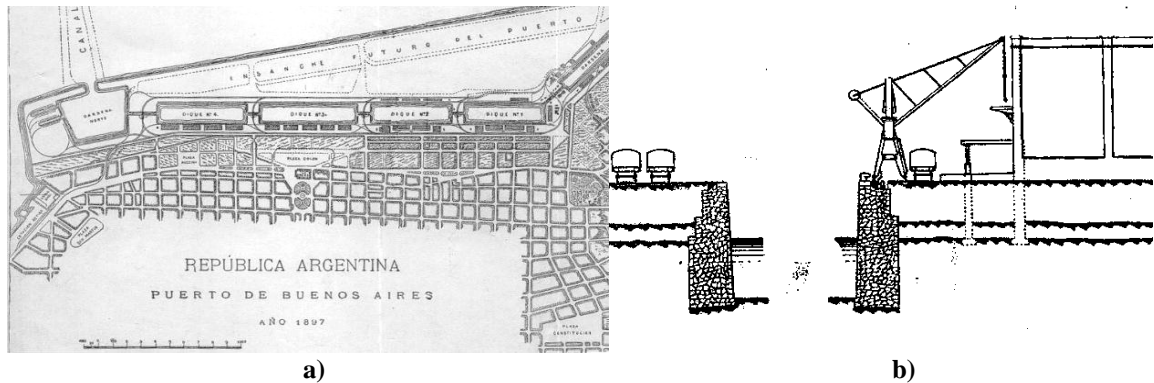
(a) Planta general; (b) corte esquemático (Schnack, 1914).
